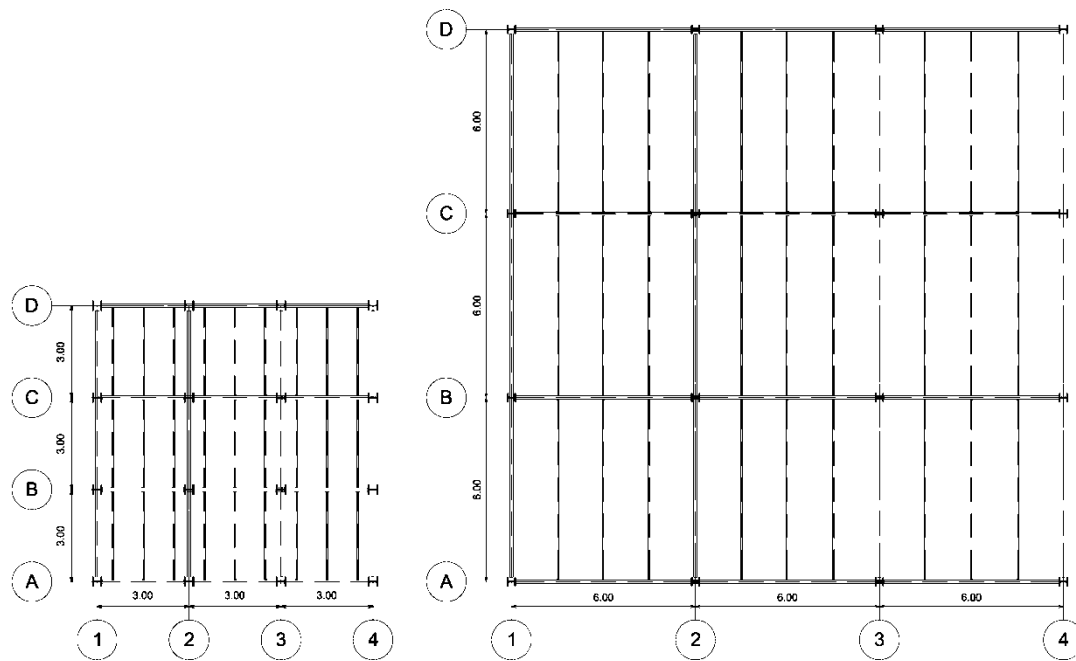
Vista en planta de las dos configuraciones estudiadas
